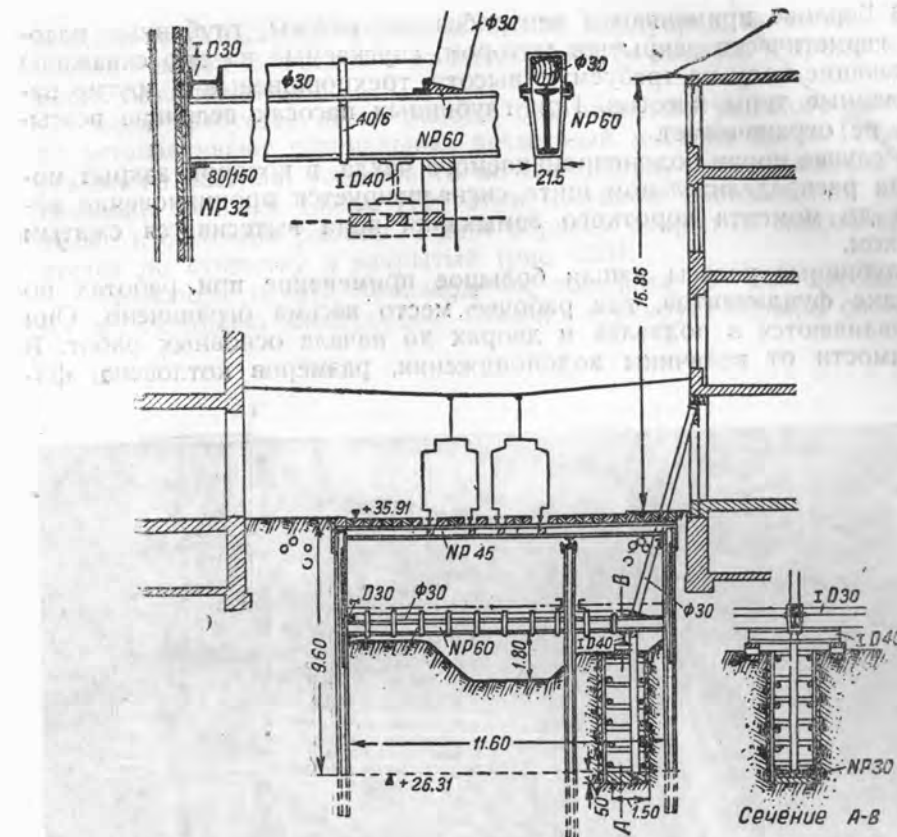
Сооружение тоннеля открытым способом вблизи домов с временным мостом для пропуска трамвайного и уличного движения. Система подкосов поддерживающих фасадную стену, опирающихся в независимые от конструкции крепления самого котлована, в отдельных колодцах.
